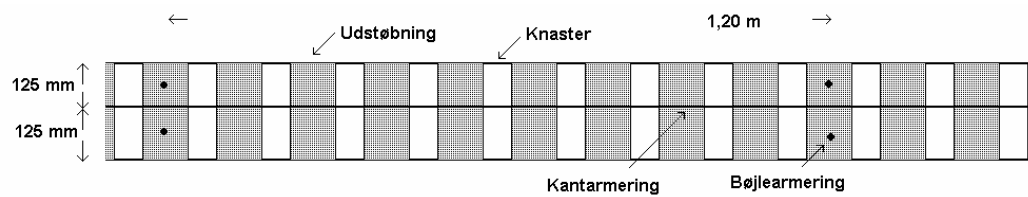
Betondæk med udstøbning. Optagelse af last mellem bøjler
